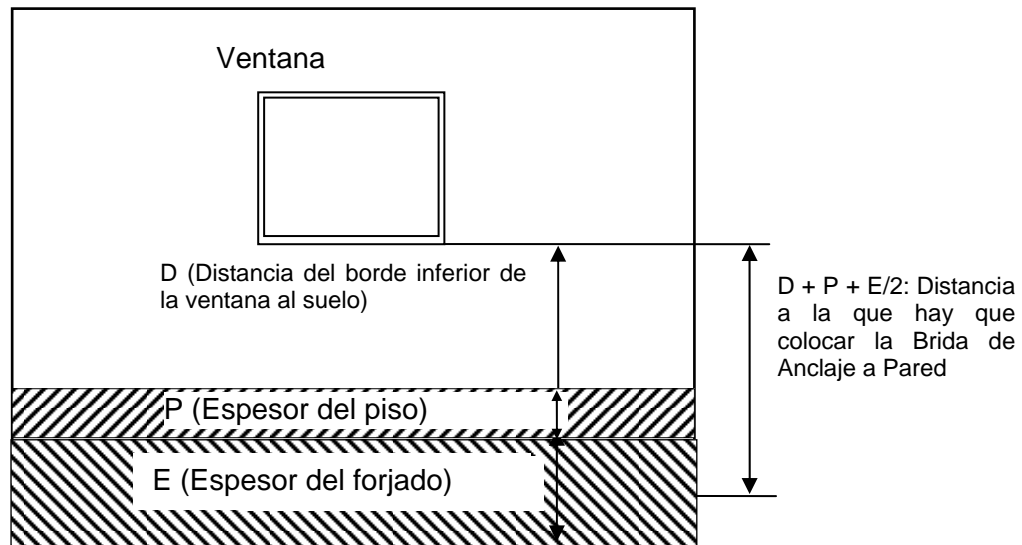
Cálculo de la posición del forjado en la fachada
